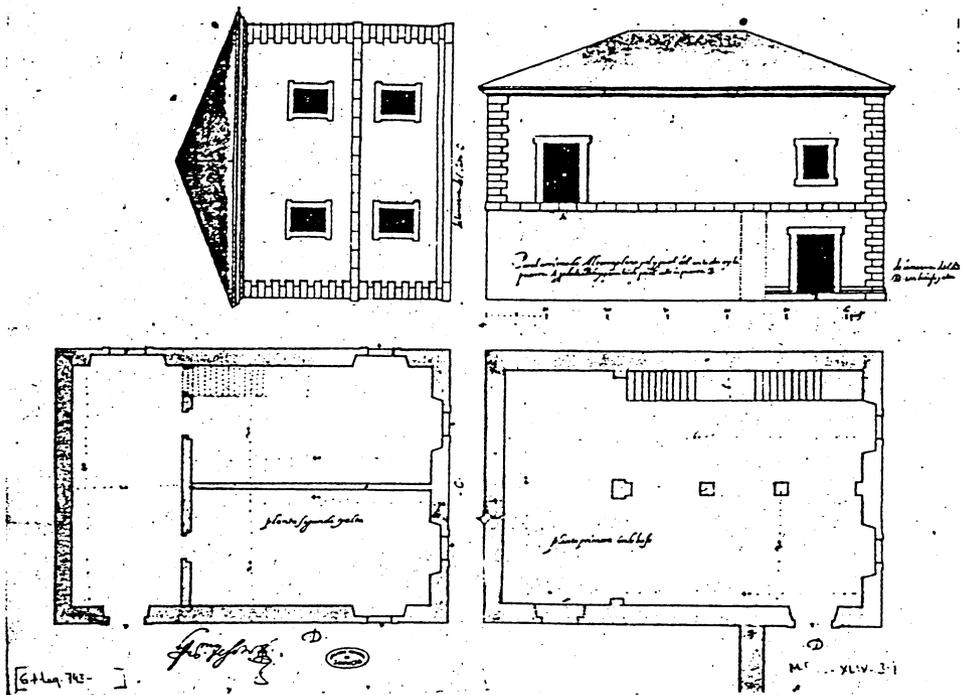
Jerónimo de Soto, planta y alzado del polvorín de Fuenterrabía (Mayo de 1610). Archivo General de Simancas, M. P. y D. XLIV-39.
